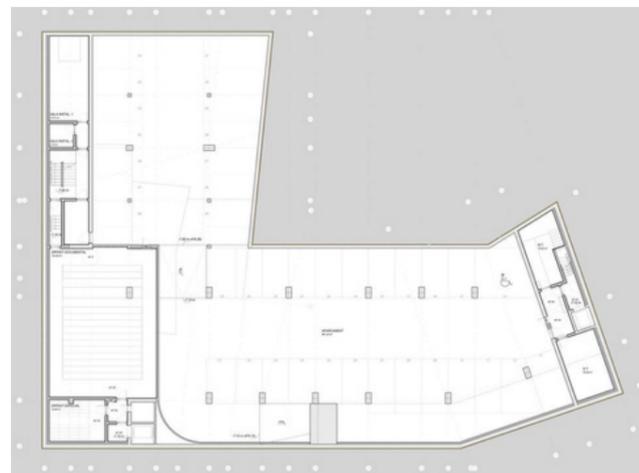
Subterráneo 2 Biblioteca Pilarín Bayés
